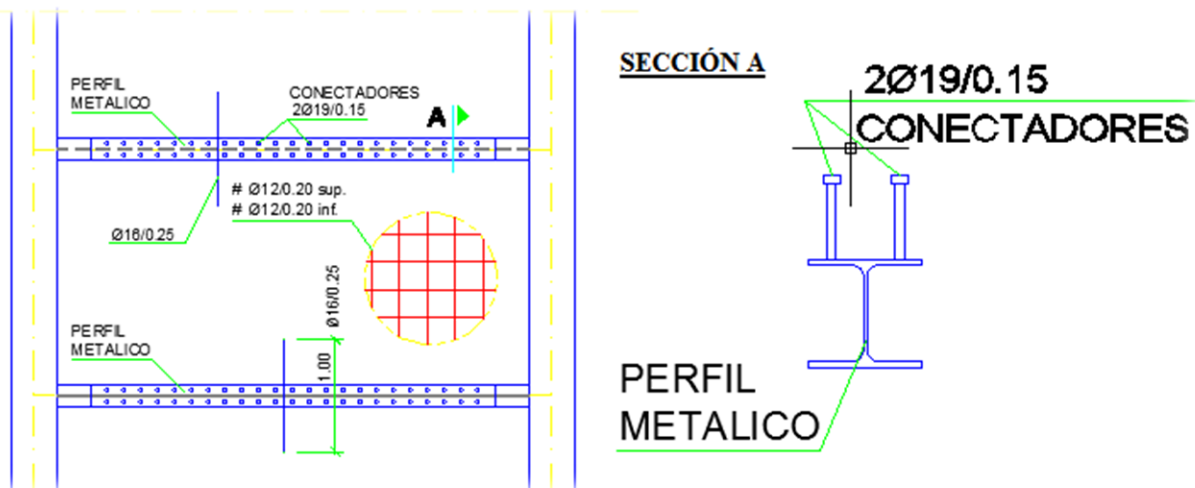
Detalle de conexión de las vigas en H y los conectadores de la solera. Fuente: Acciona.
